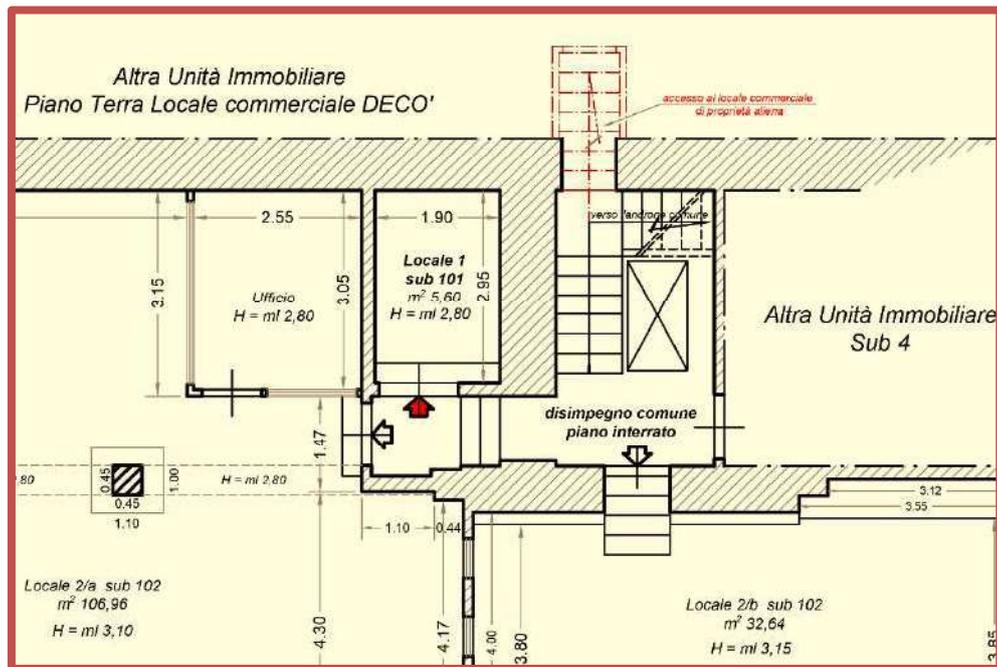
Stralcio planimetrico fuori scala dell'accesso al "Locale 1 Sub 101".
